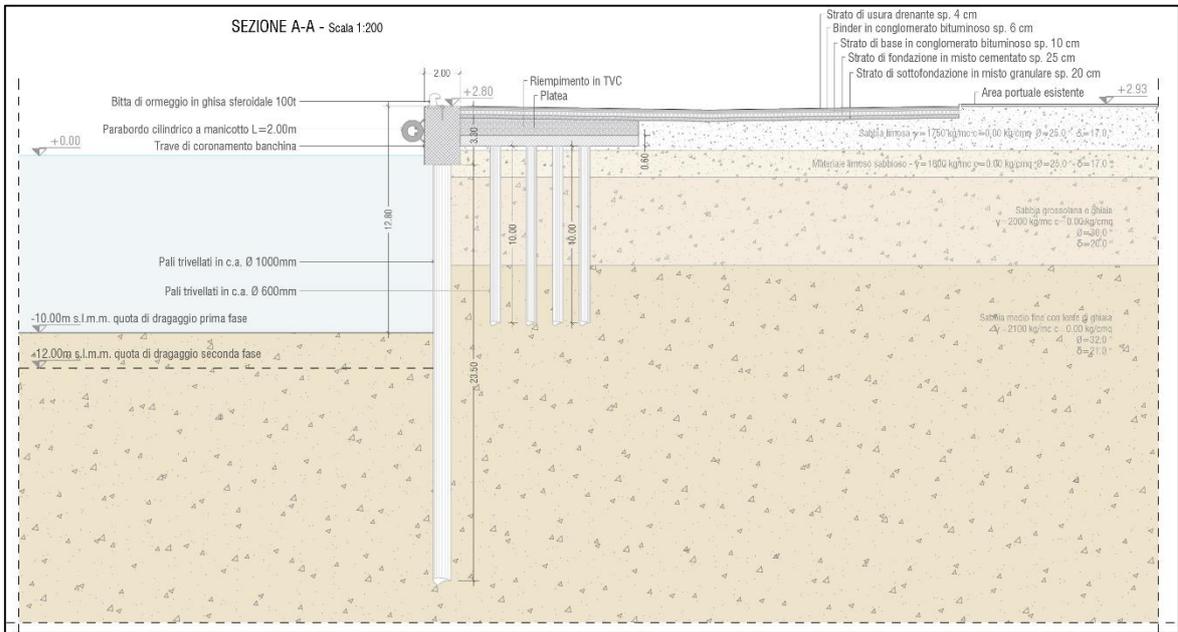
Banchina di progetto - Sezione Tipo A-A (Elab. EG.09)
